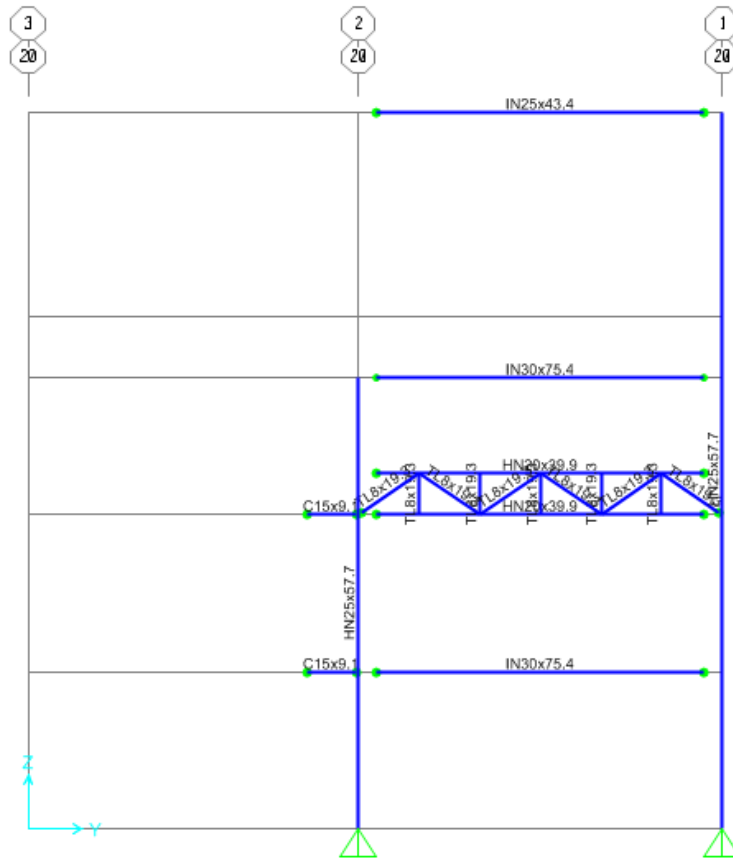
Planta Elevación 9.31 m sobre el nivel de terreno.
